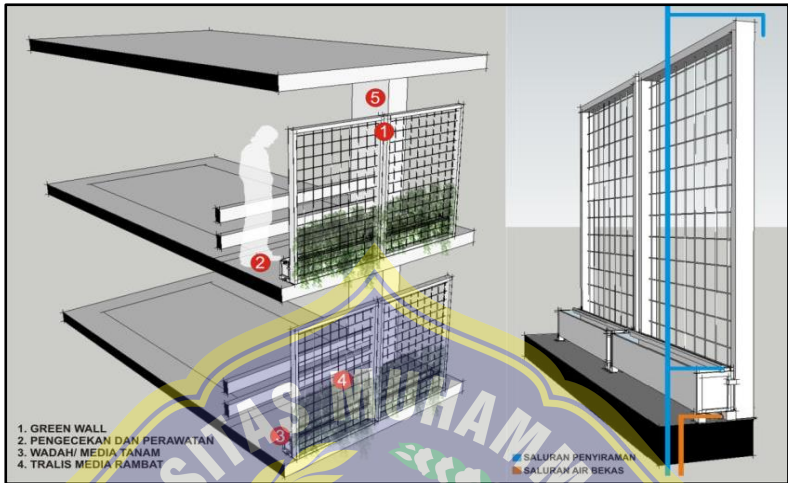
Contoh bentuk gedung *Green Facade
